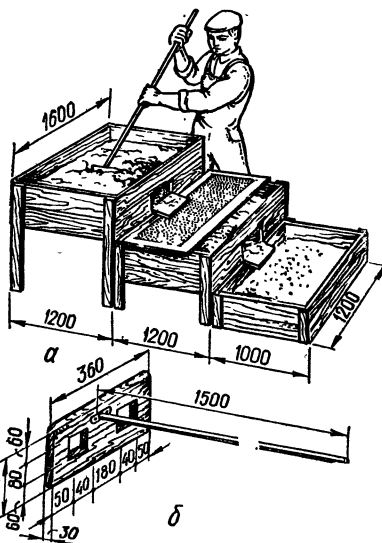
Установка Корнеева для приготовления глиняного раствора:
